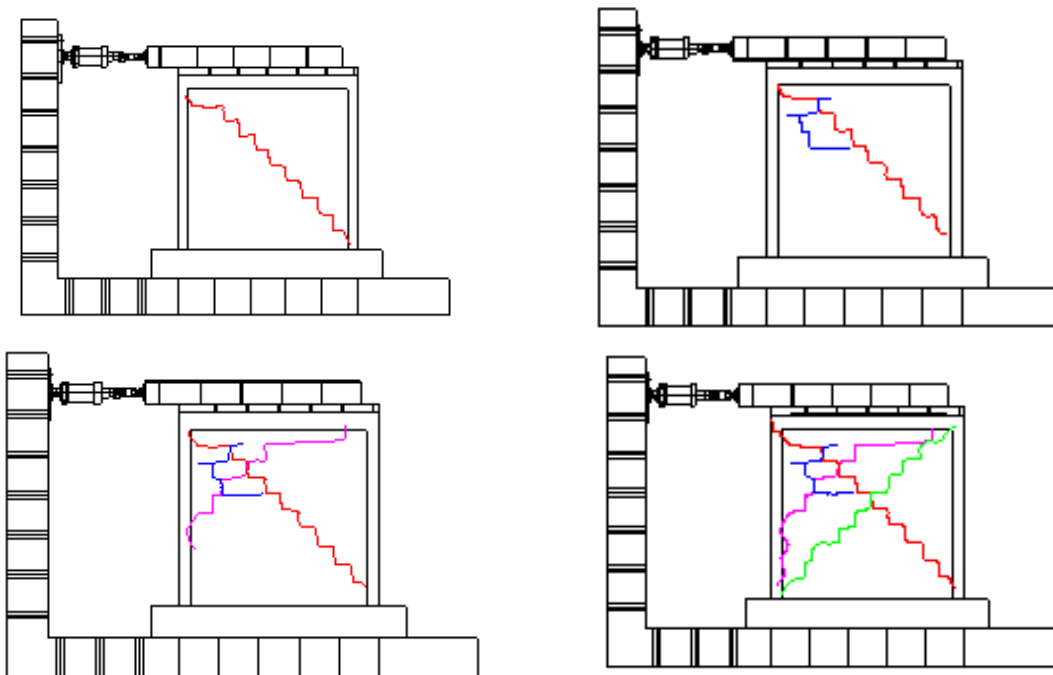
Aparición de grietas durante el ensaye de muro construido con piezas de block de concreto ligero (Jaen, 2015).
